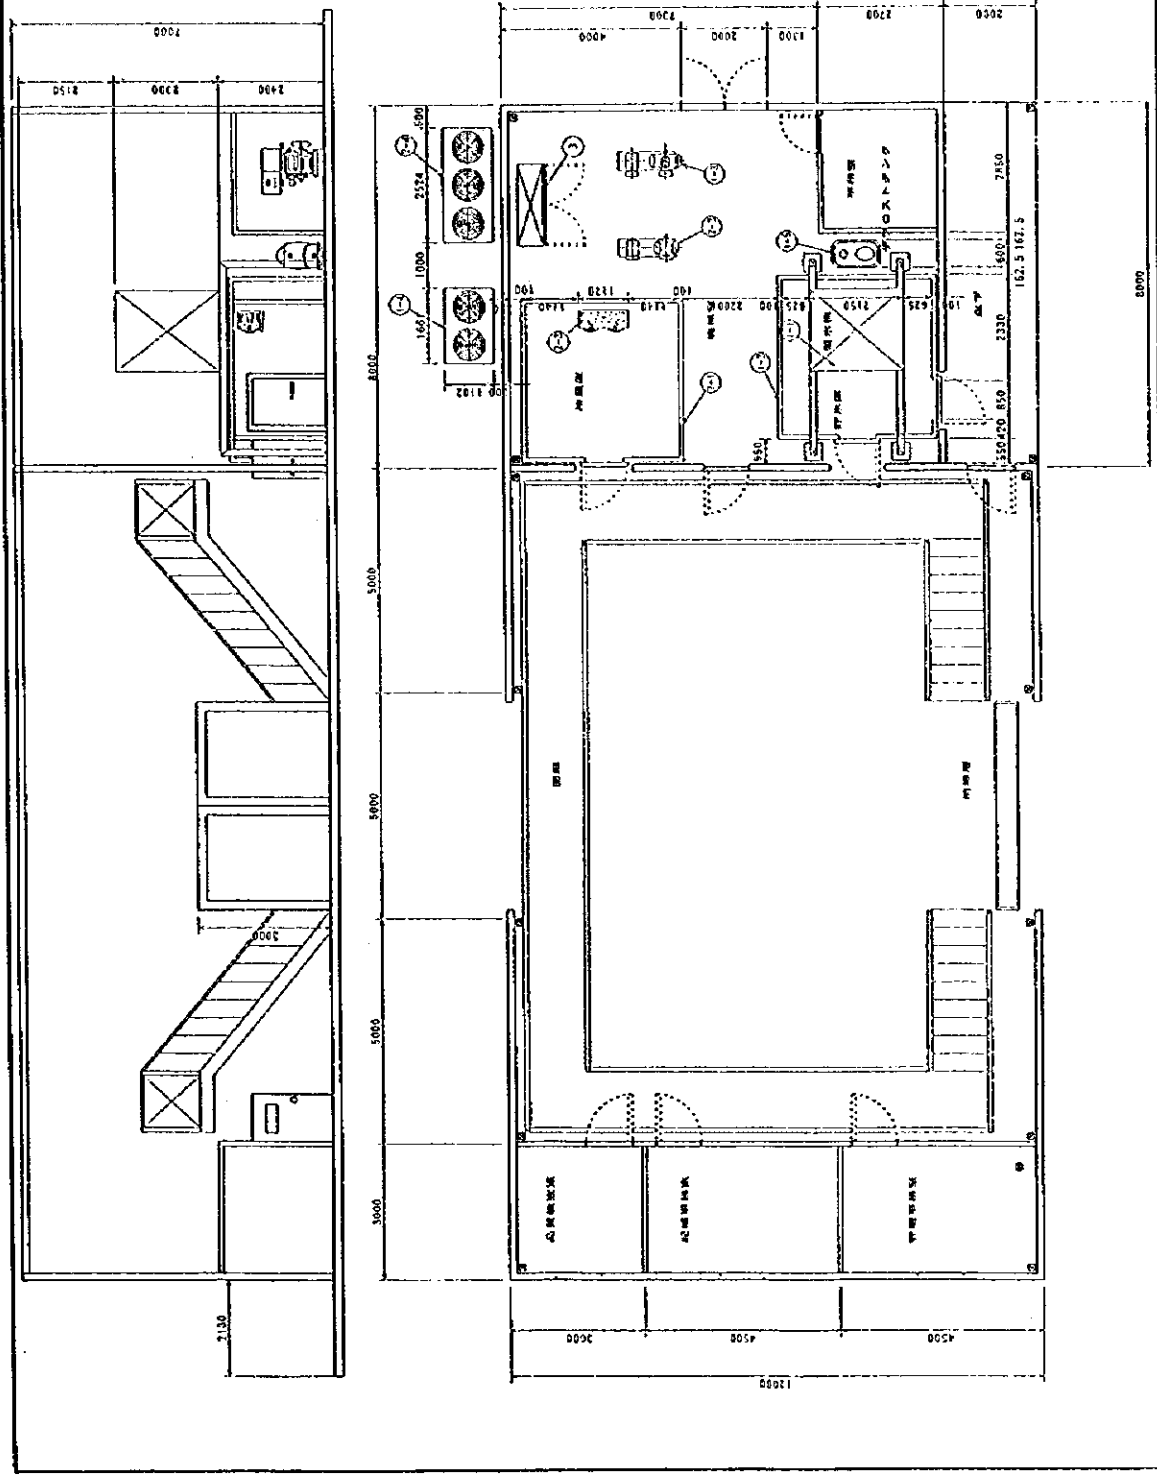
(8) 製氷・冷蔵・貯氷装置の配置図
